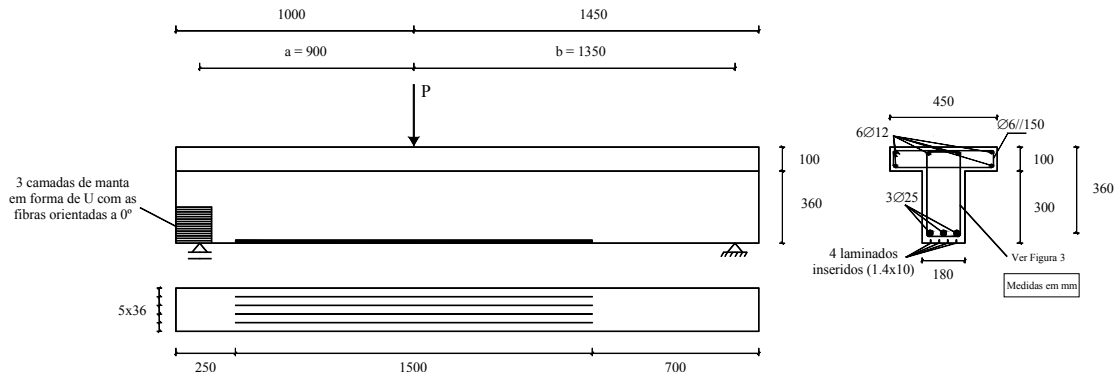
Vigas ensaiadas: geometria, armaduras comuns a todas as vigas, reforço à flexão com laminados de CFRP e reforço do canto inferior esquerdo com manta de CFRP
